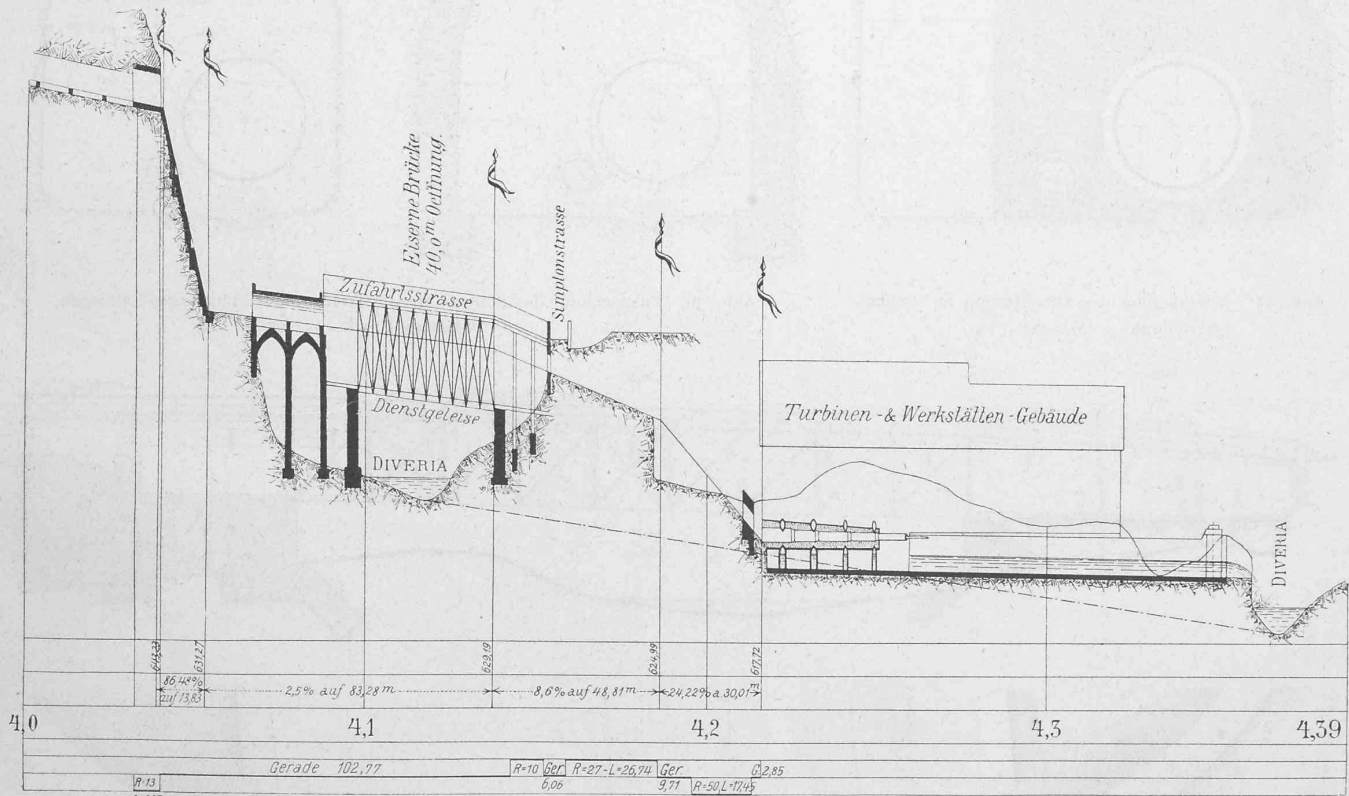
Längenprofil der Druckleitung vom Stollenausgang bis zum Maschinenhaus.
